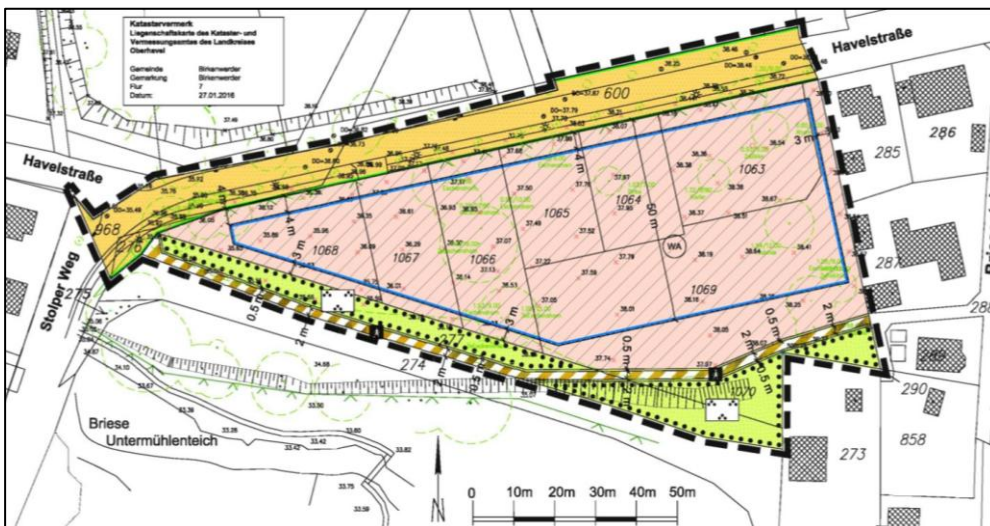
Bebauungsplan Nr. 37-1 „Wohngebiet Havelstraße – Am Paradiesgarten“<sup>15</sup>
